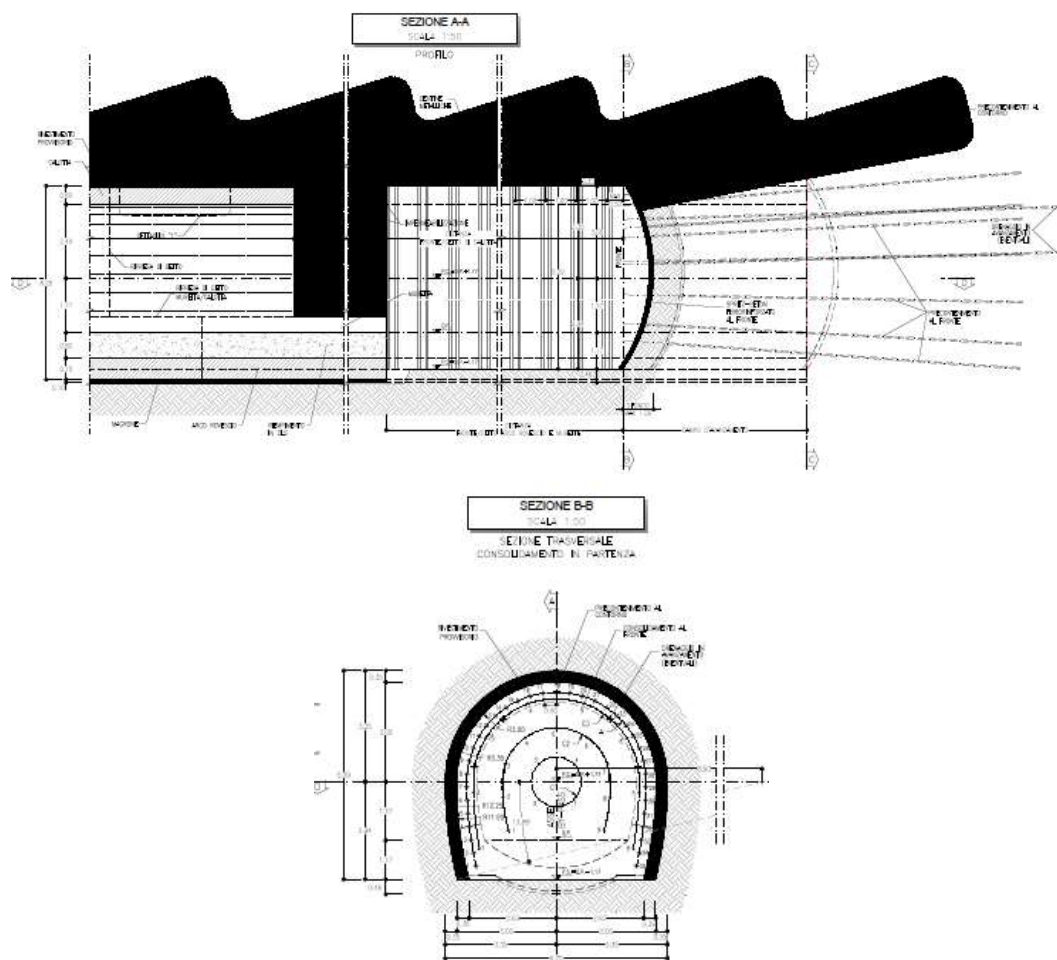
Sezione tipo C2 bypass area di sicurezza
